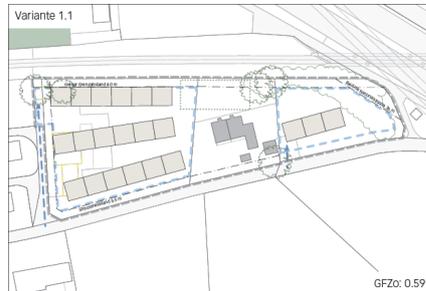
Variante mit Reihen-EFH und unterirdischer Parkierung
